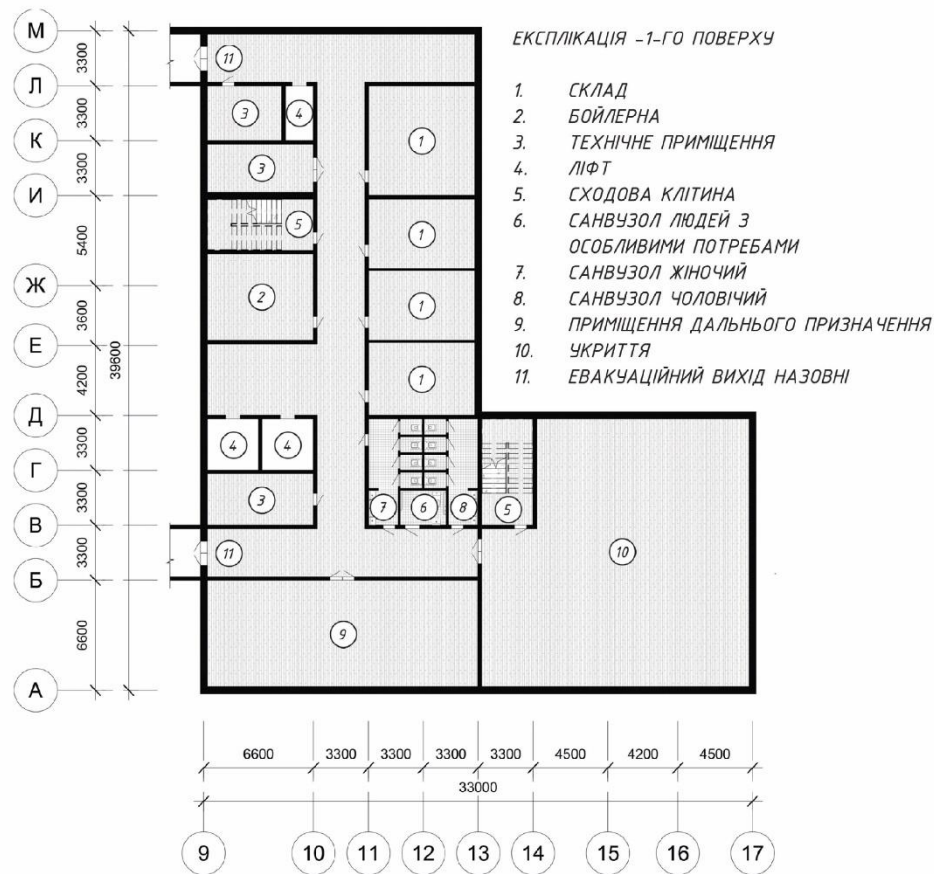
План -1-го поверху на відмітці -3.300 м
